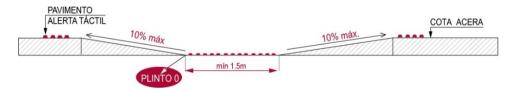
Cruce peatonal rebajado en una vereda de ancho inferior a 1,2m. La vereda baja en todo su ancho hasta alcanzar la cota de la calzada.
